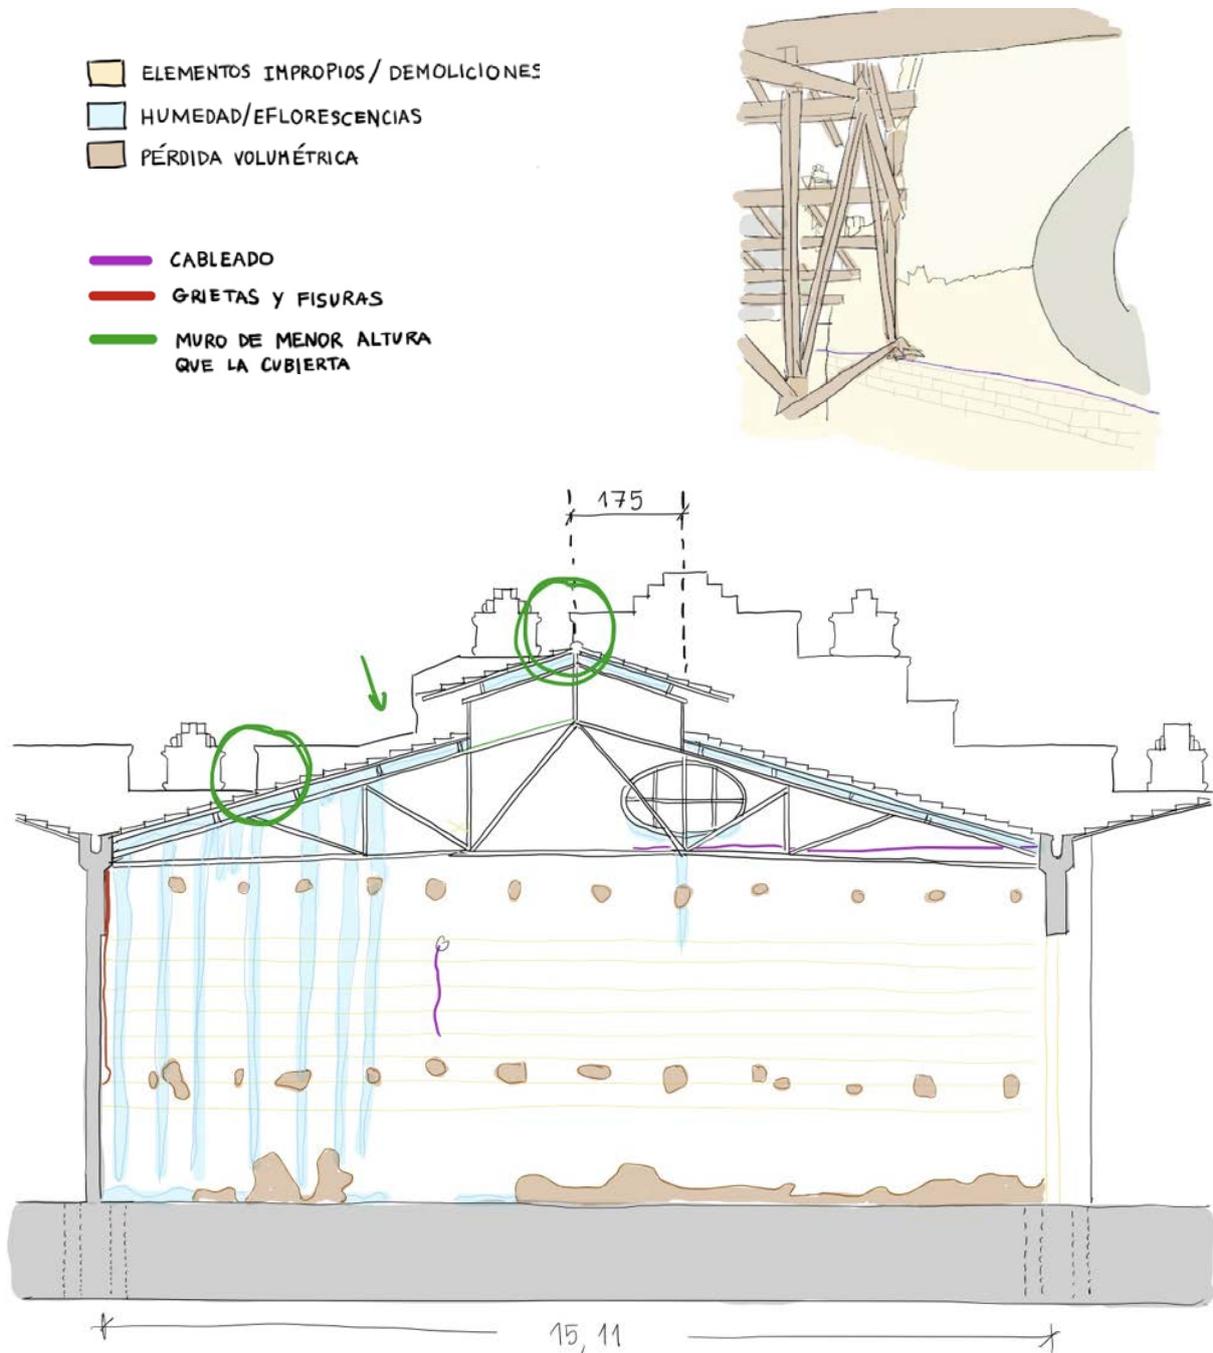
Patologías del alzado interior del muro posterior de la nave 3. Referencias en el plano B.12 realizado durante la fase del Proyecto Básico Modificado firmado por J. Ramón Esteve Cambra en abril de 2017. Fuente: elaboración propia.
